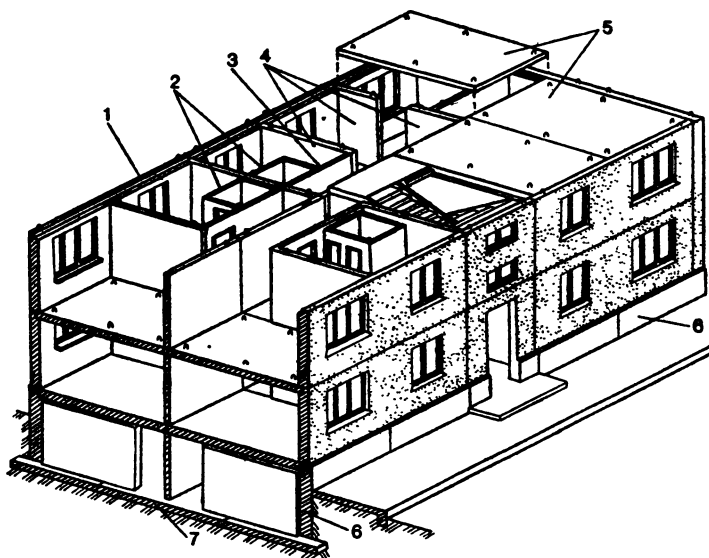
Конструктивная схема крупнопанельного дома с несущими стенами-перегородками:
